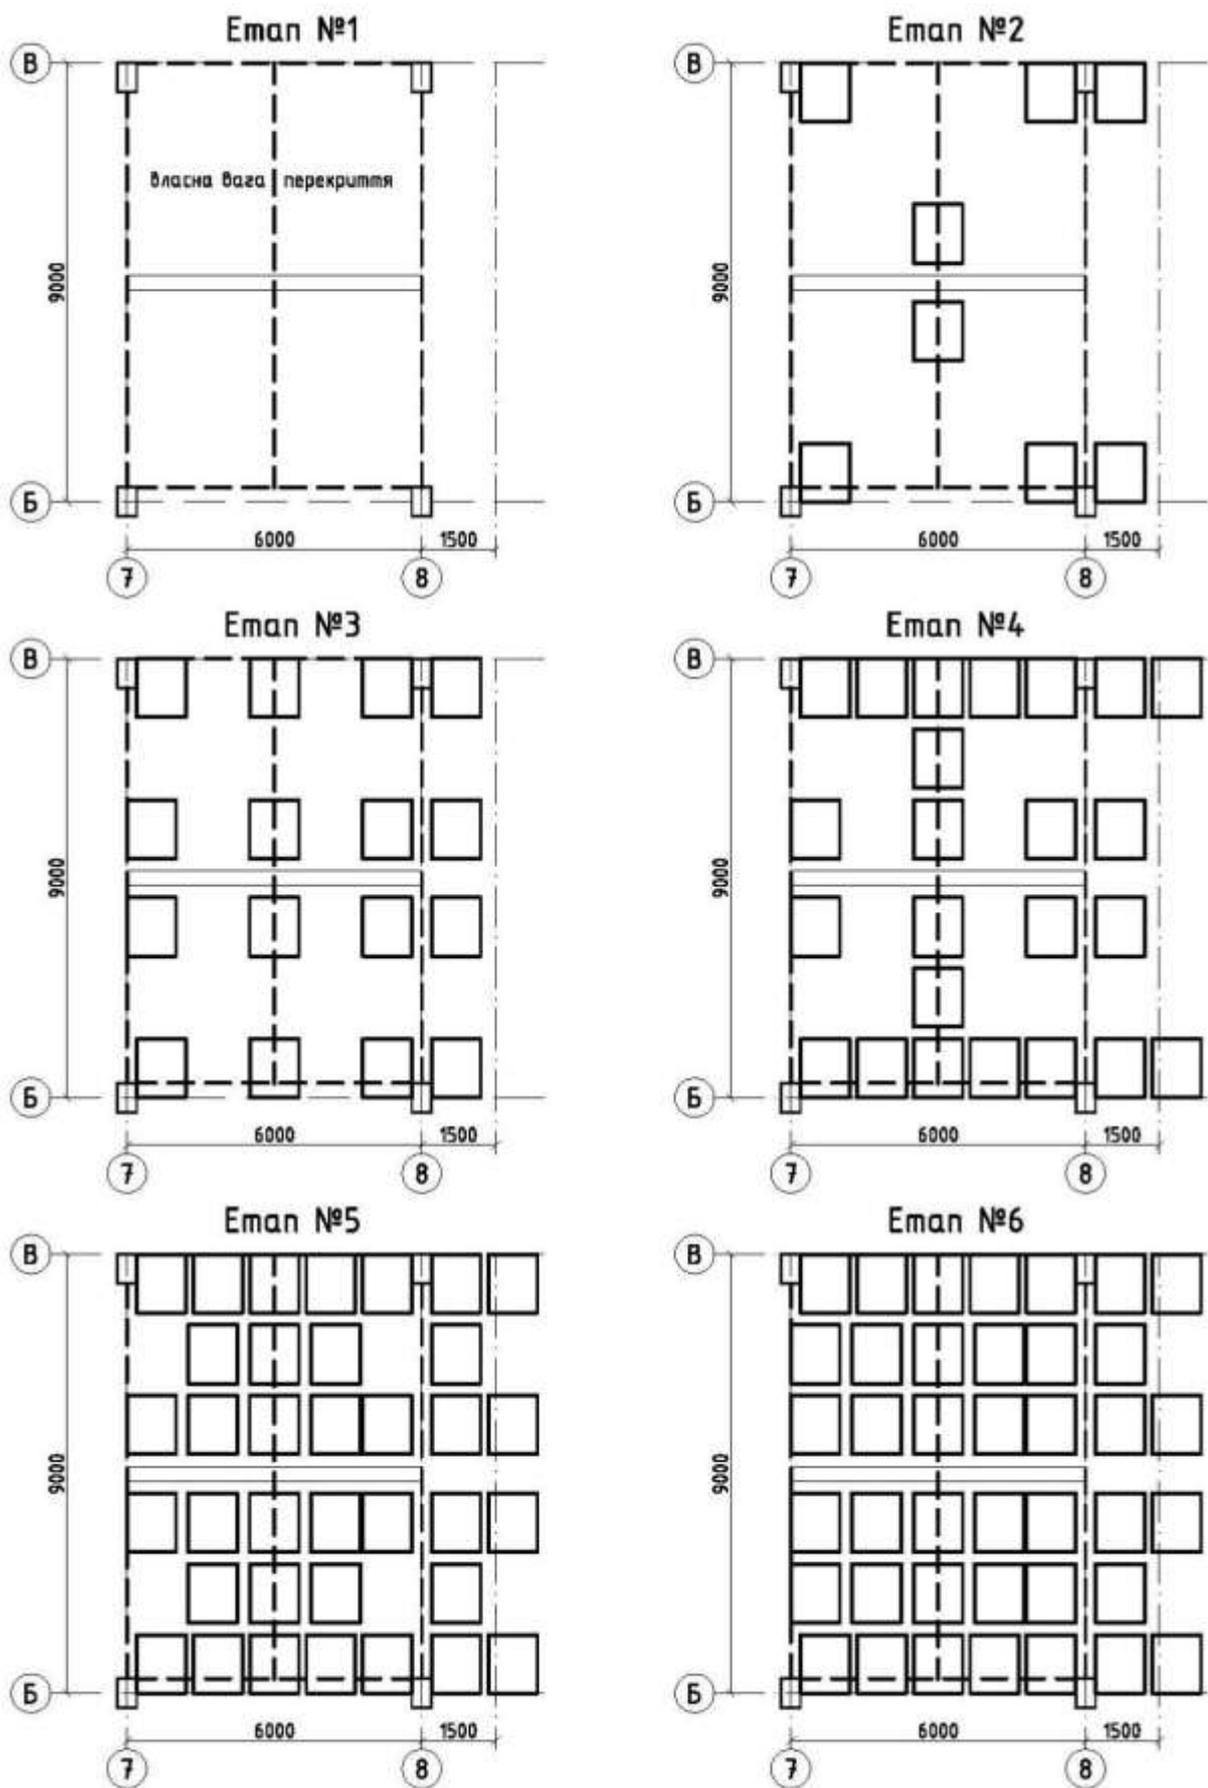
Схеми завантажень ділянки СЗБ перекриття
